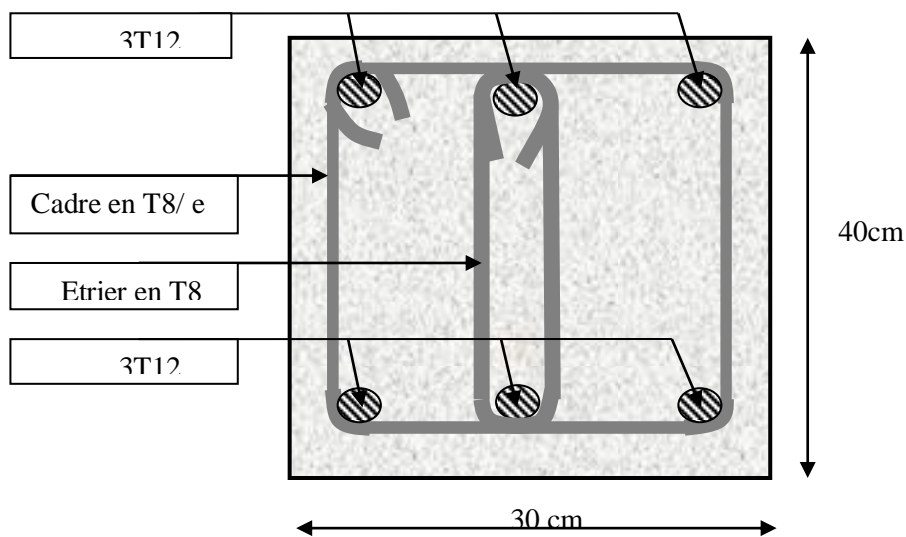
Schéma de ferrailage de poutre palière.
